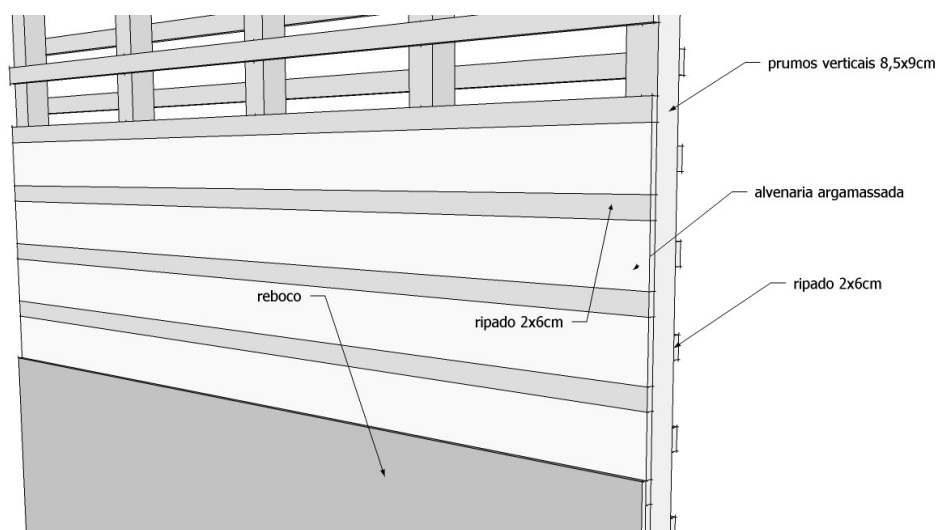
Sistema construtivo identificado em Coruche – desenho esquemático.
